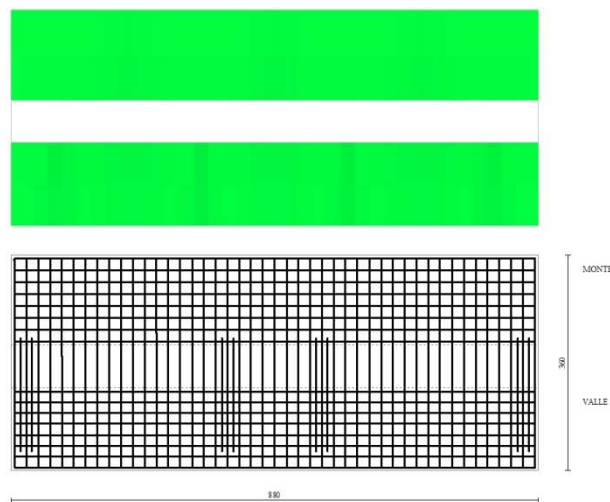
Piastra fondazione dir. X (Inviluppo)
